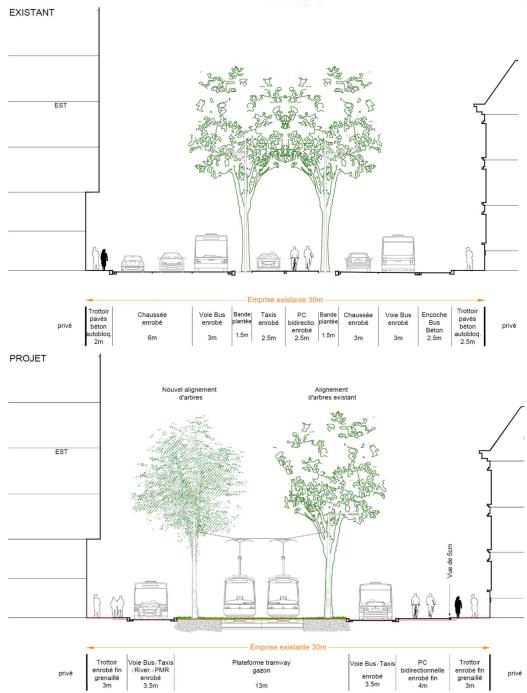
Coupe Boulevard de Metz (source : AVP GETAS 2023)
